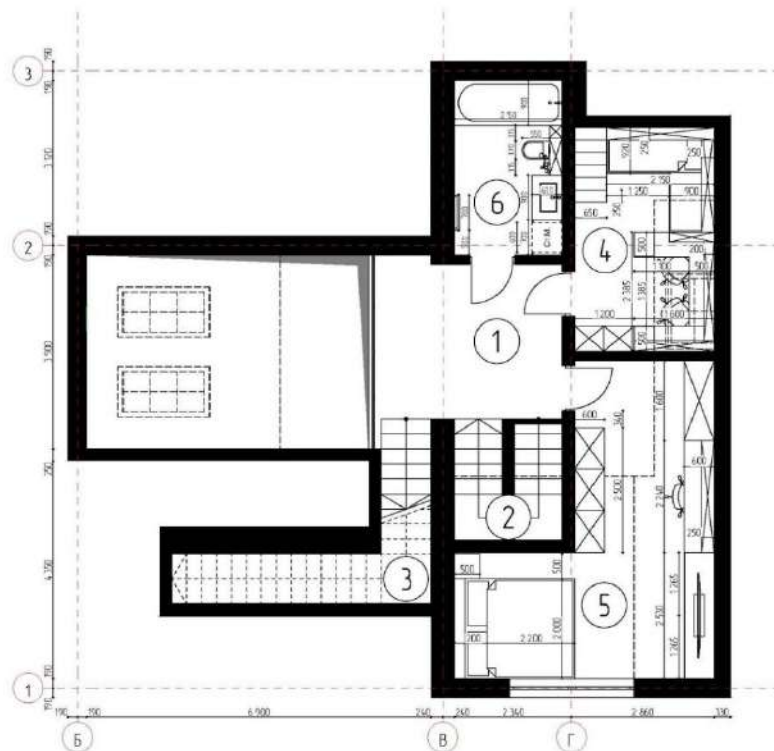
Планувальне рішення для 2-го поверху квартири (авторське креслення).
